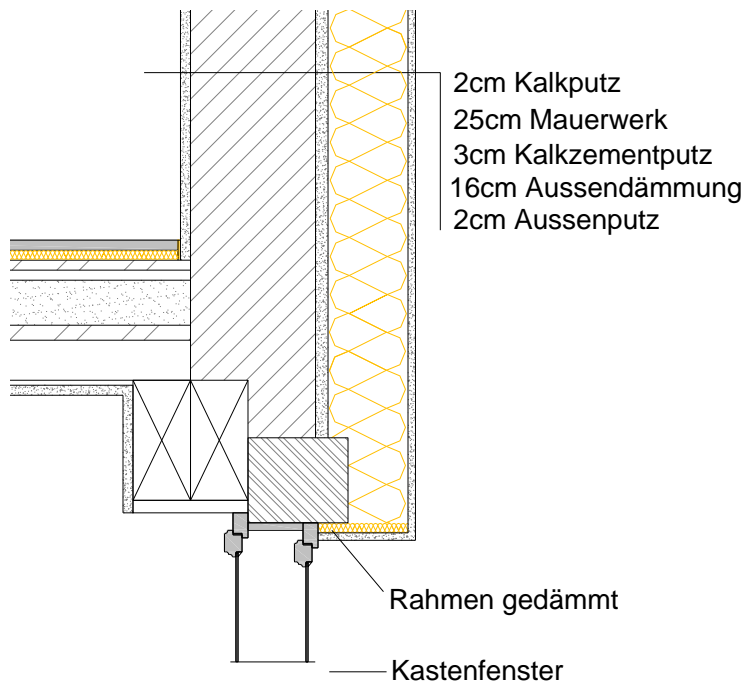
Fensteranschlussdetail Sturz bei Kastenfenster mit Aussenwärmedämmung und Leibungsdämmung
